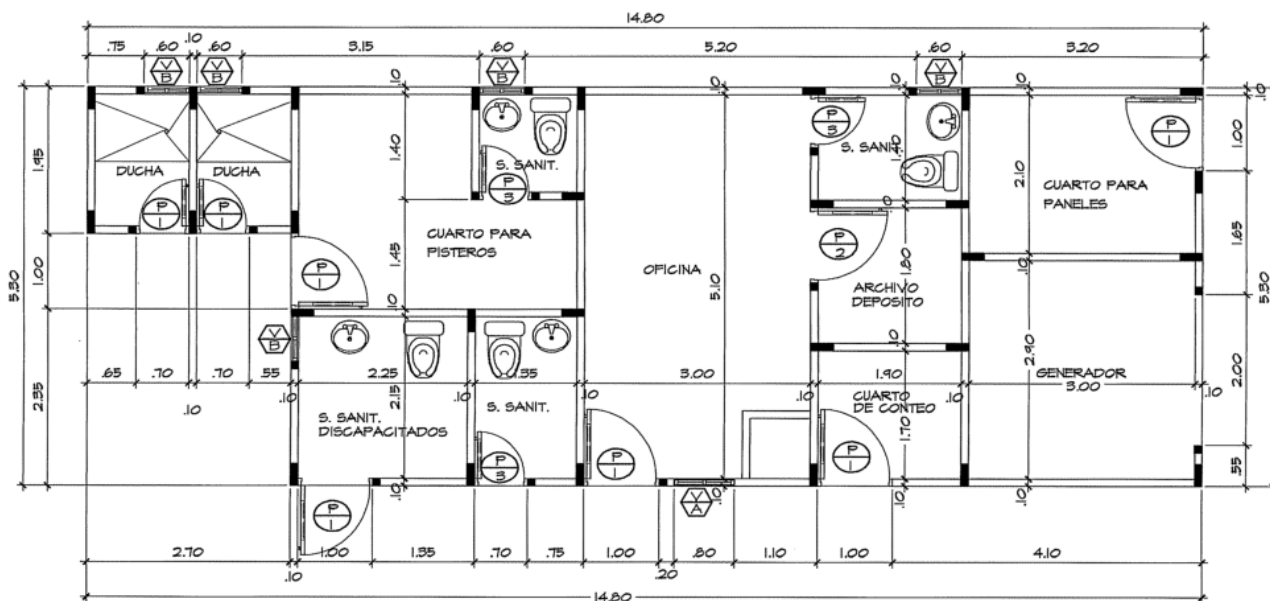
PLANTA ARQUITECTÓNICA - OFICINA
